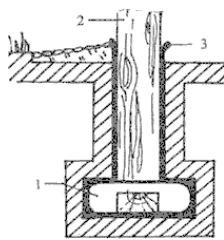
Деревянный стул с крестовиной: 1 – крестовина; 2 – бревно; 3 – гидроизоляция.
